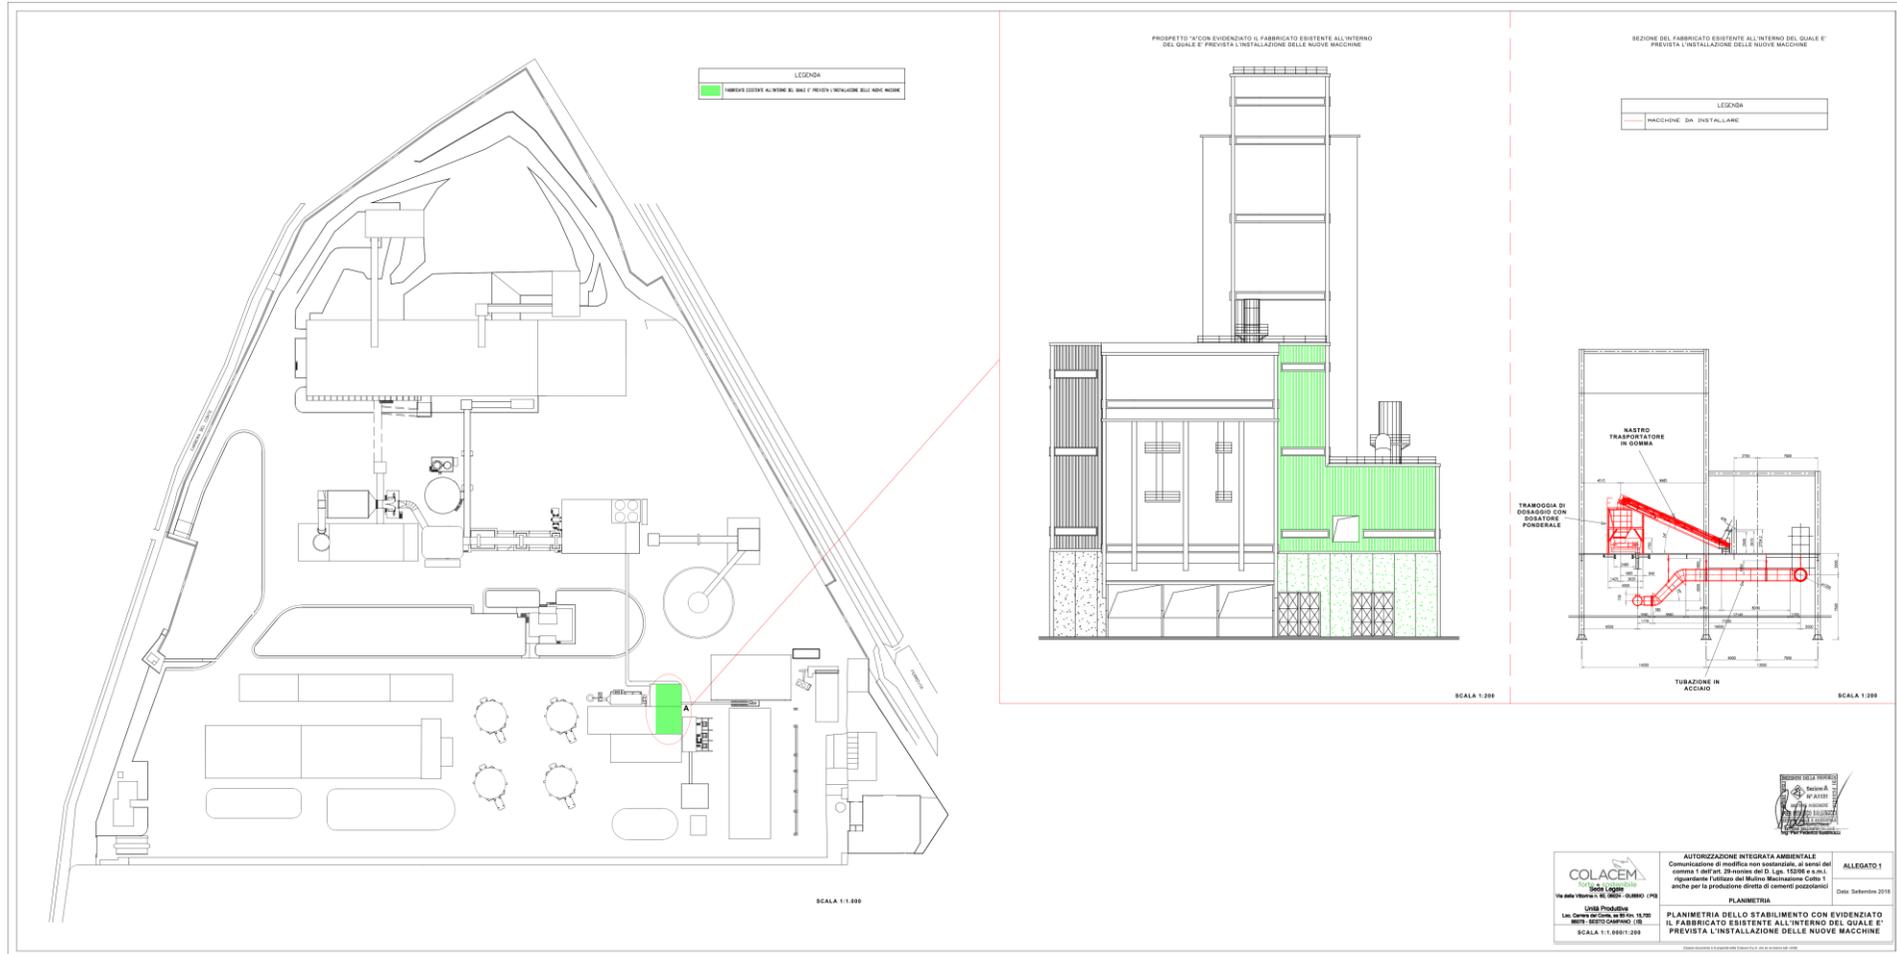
planimetria generale dell'installazione con indicazione dell'area di intervento
